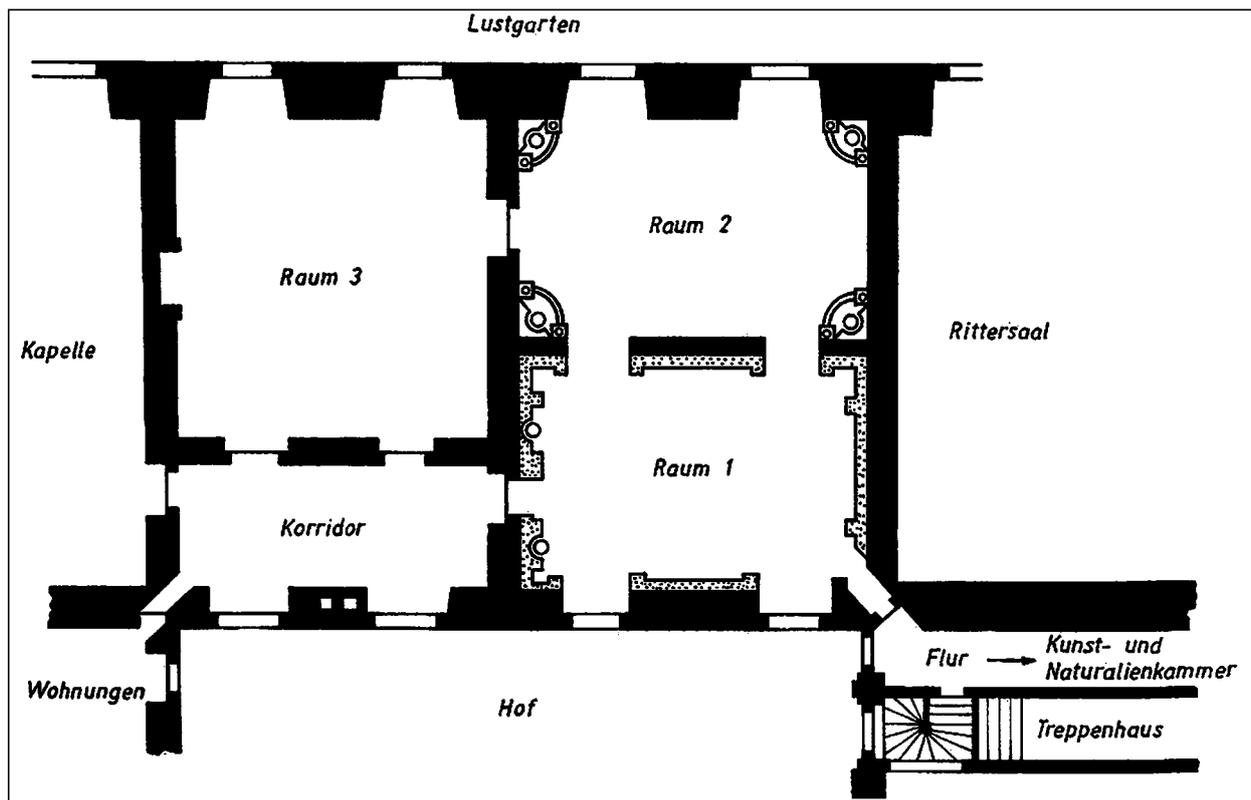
Grundriss des Antikenkabinetts im Berliner Stadtschloss nach 1703.
